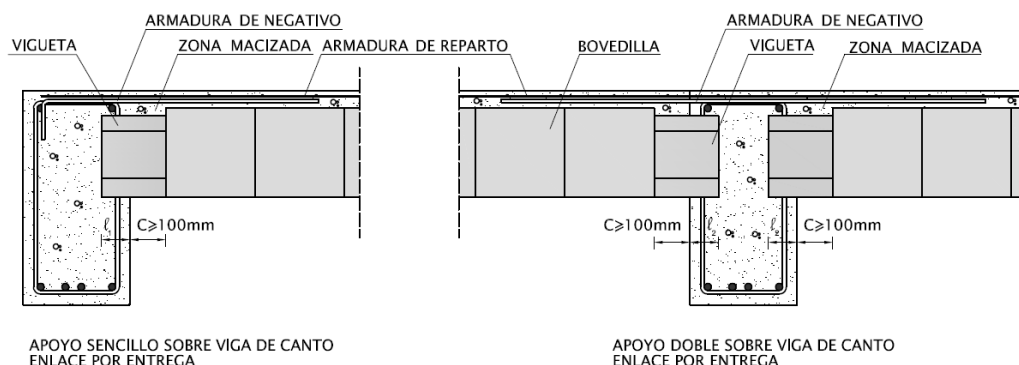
Apoyo sobre viga de canto. Enlace por entrega
